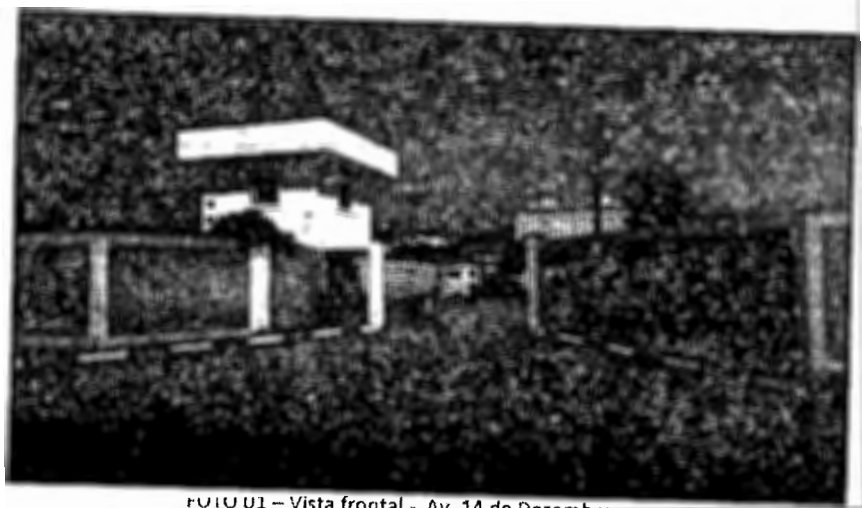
Vista frontal - Av. 14 de Dezembro
